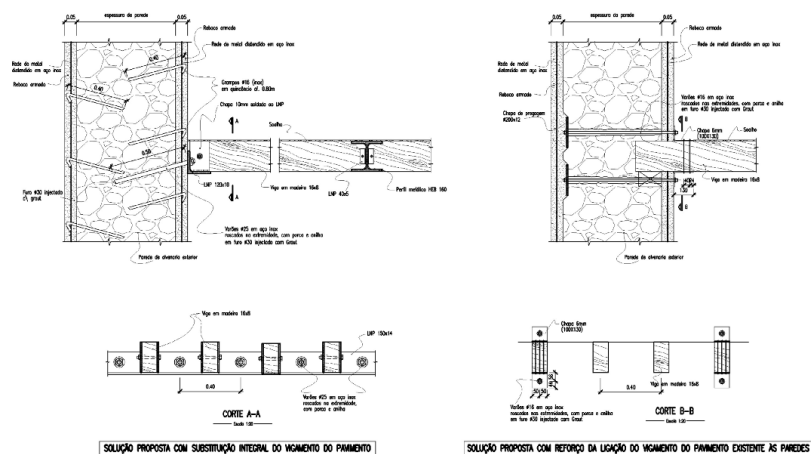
Ligações dos vigamentos dos pavimentos às paredes de alvenaria existentes
